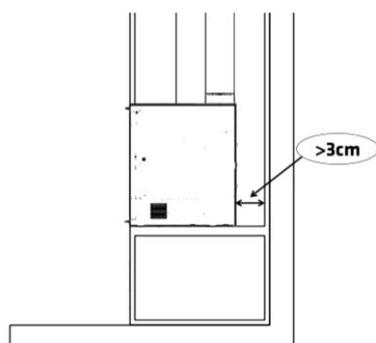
Separazione tra l'apparecchio e la parete posteriore
